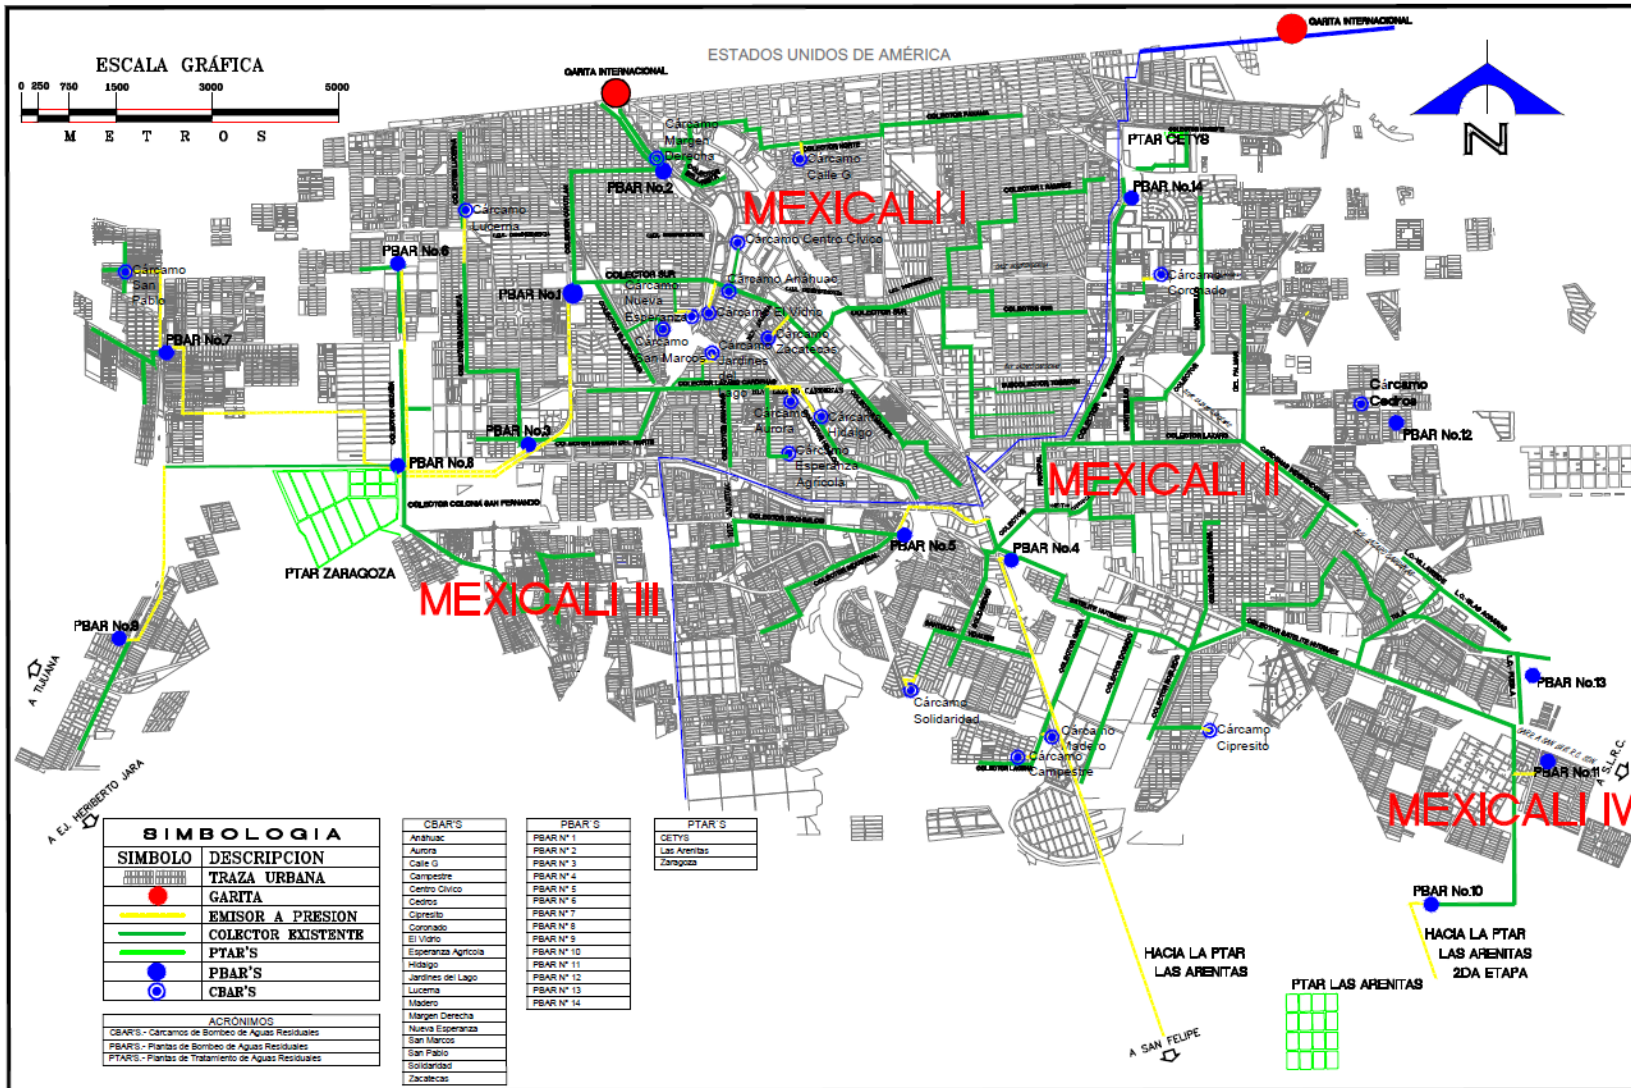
Plano del sistema de alcantarillado y saneamiento de la ciudad de Mexicali.
